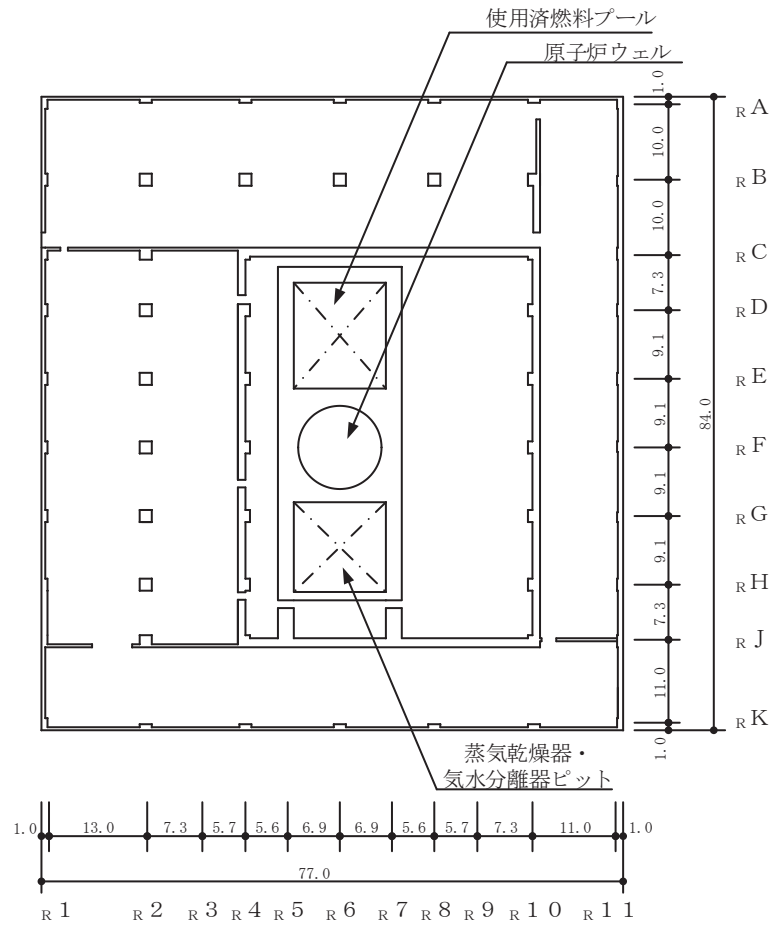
使用済燃料プールを含む原子炉建屋の概略平面図 (0.P. 33. 2m)
